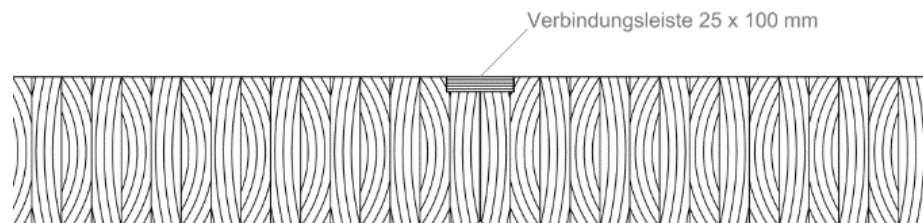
Stoßausbildung Brettstapelelement – eingelassene Decklage
